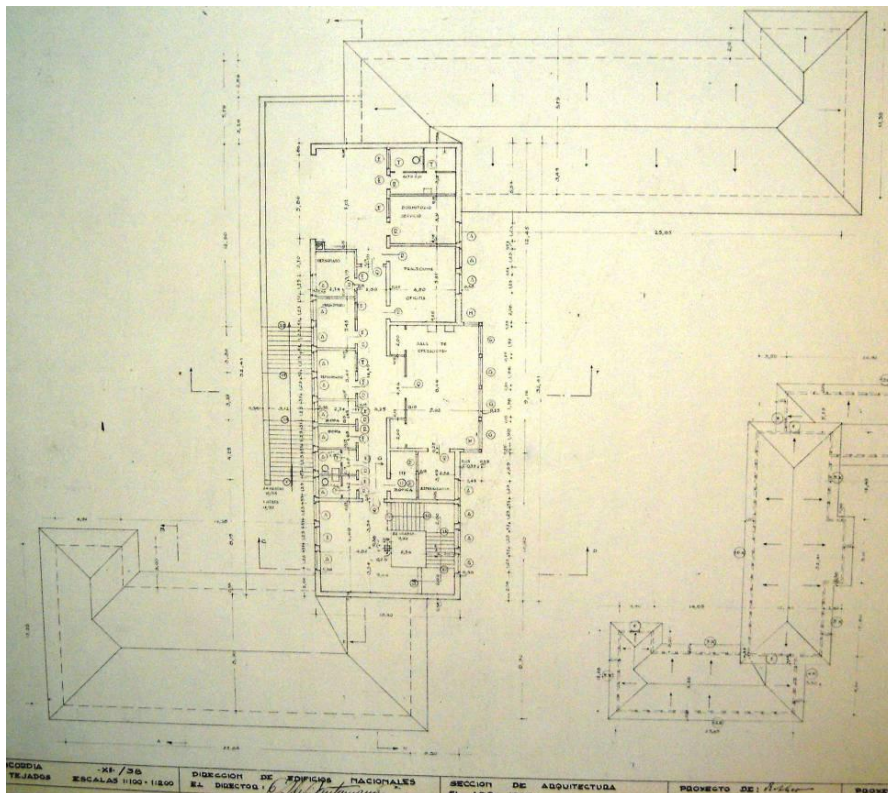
Grundriss des Obergeschosses, von Rother gezeichnet.
